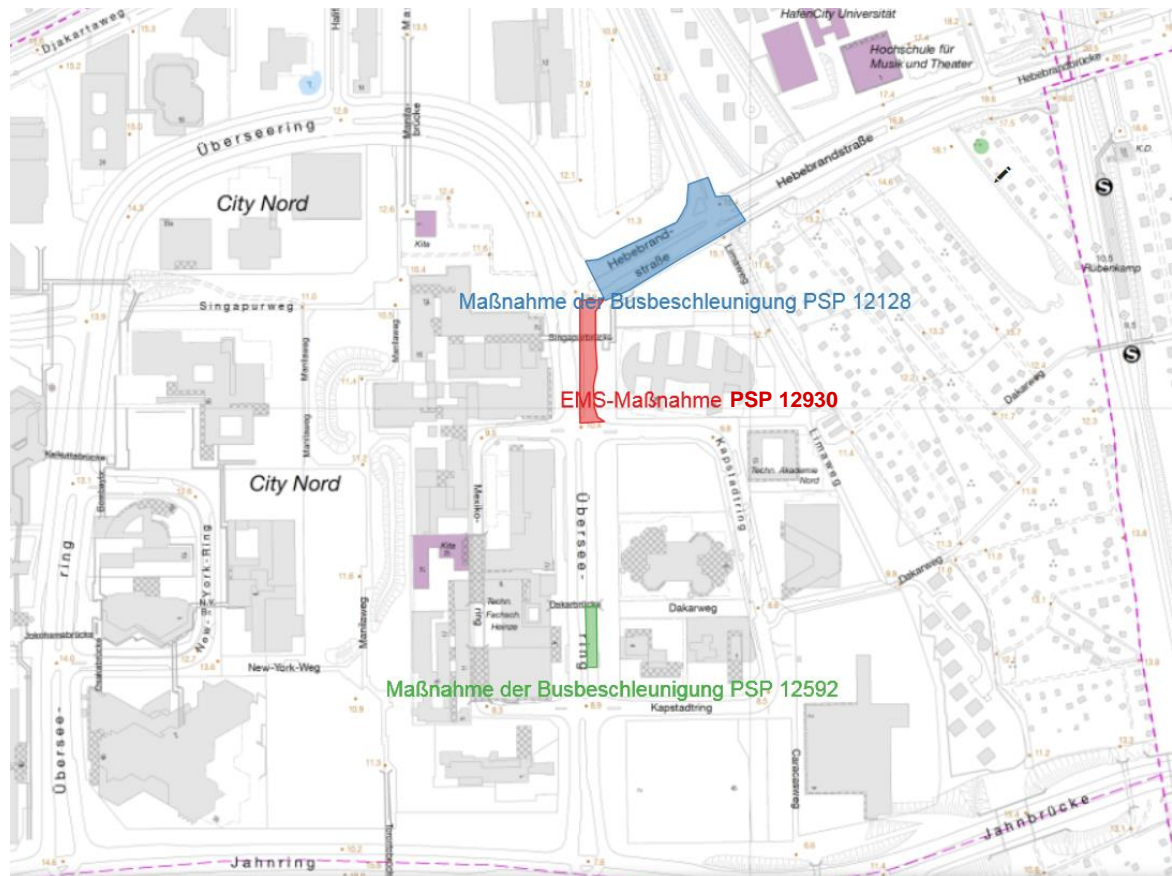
Lageplan aller Maßnahmen auf dem Überseering Ost
